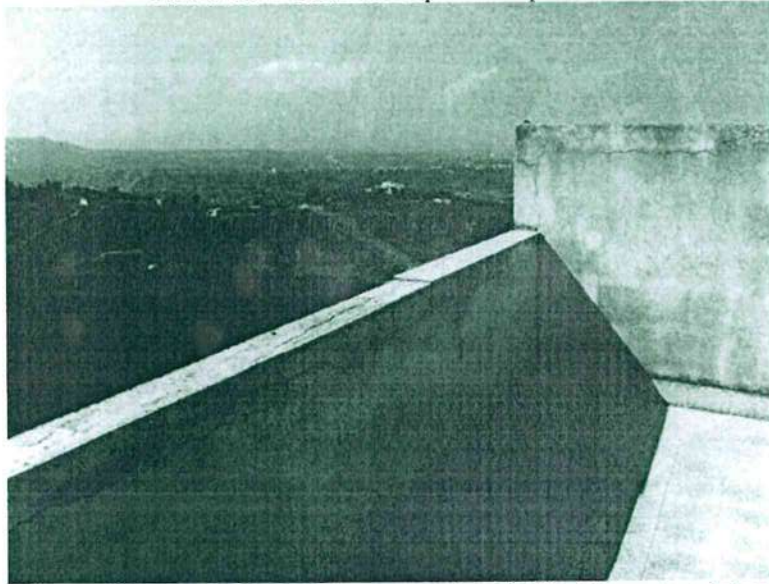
Distacco di intonaco nel parapetto per corrosione dei ferri di armatura del cordolo in c.a. e conseguente espulsione del copri ferro.
